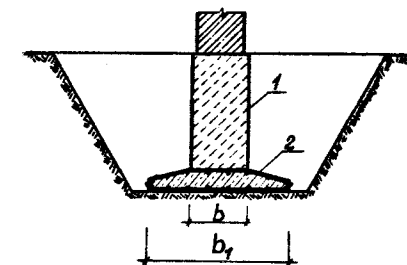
Poszerzenie fundamentu za pomocą ław betonowych
